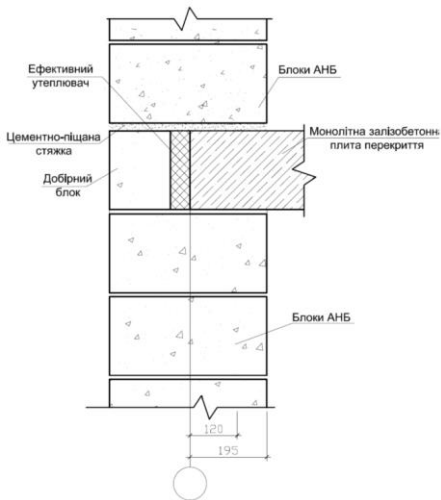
Обпирання монолітного залізобетонного перекриття на зовнішню стіну з АНБ [2]
